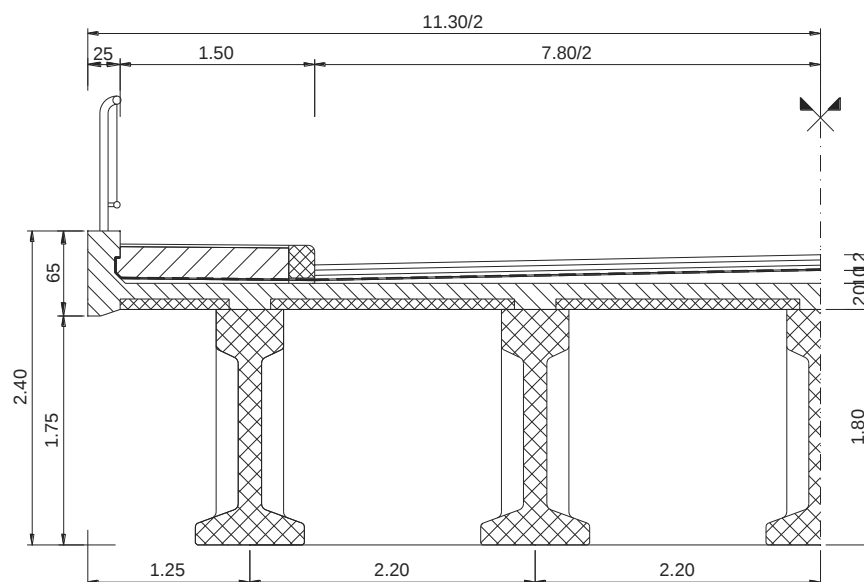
Secțiune transversală – Tablier pe grinzi prefabricate cu predale
